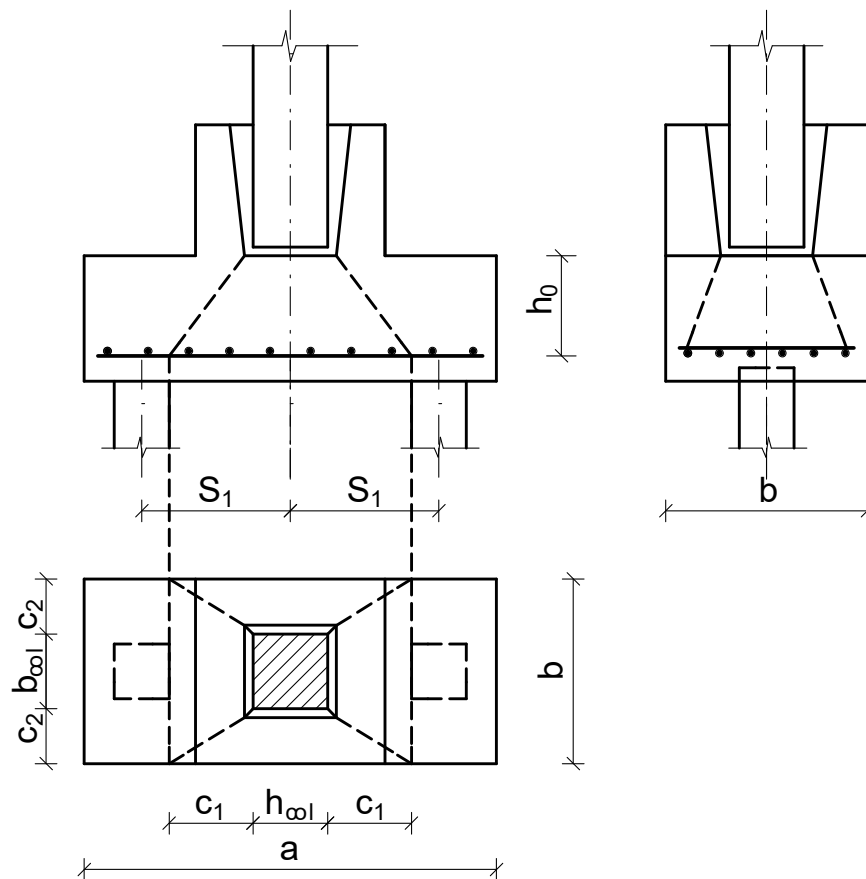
Схема утворення піраміди продавлювання під збірною залізобетонною колоною у двопальовому фундаменті
